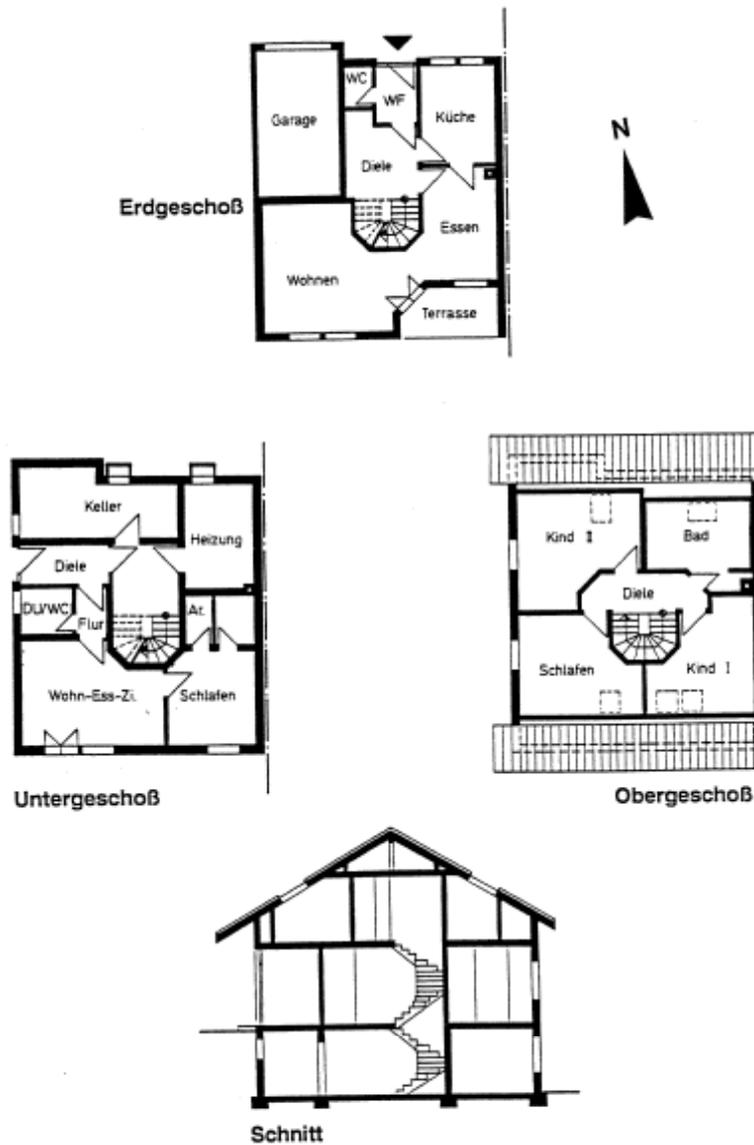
Darstellung der Grundrisse aller Geschosse und eines Schnittes des Holzhauses (Reiß und Erhorn 1994)
